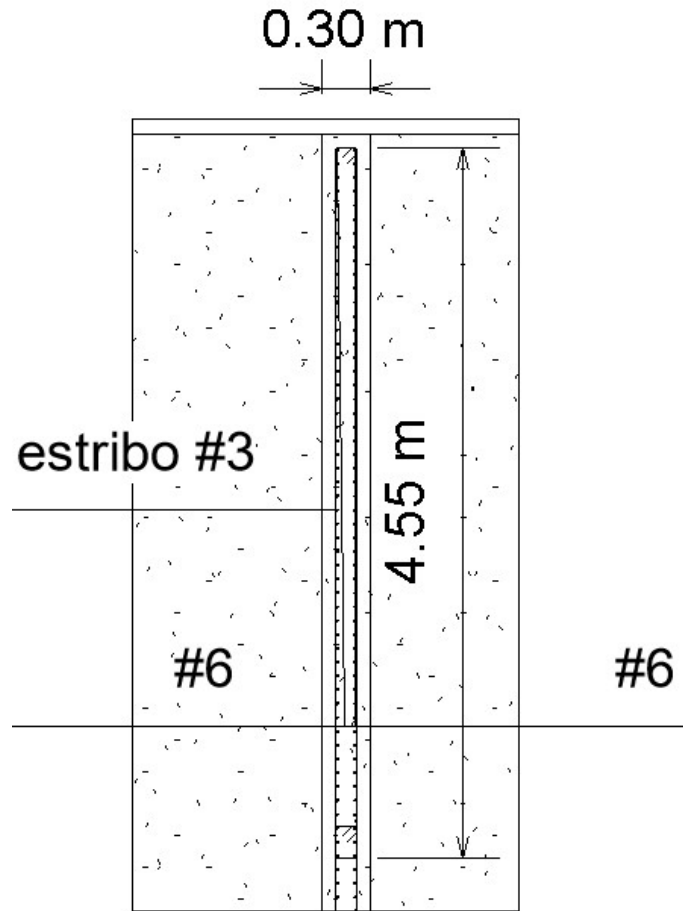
Detalle del refuerzo longitudinal de muro interno de alcantarilla de una celda.
